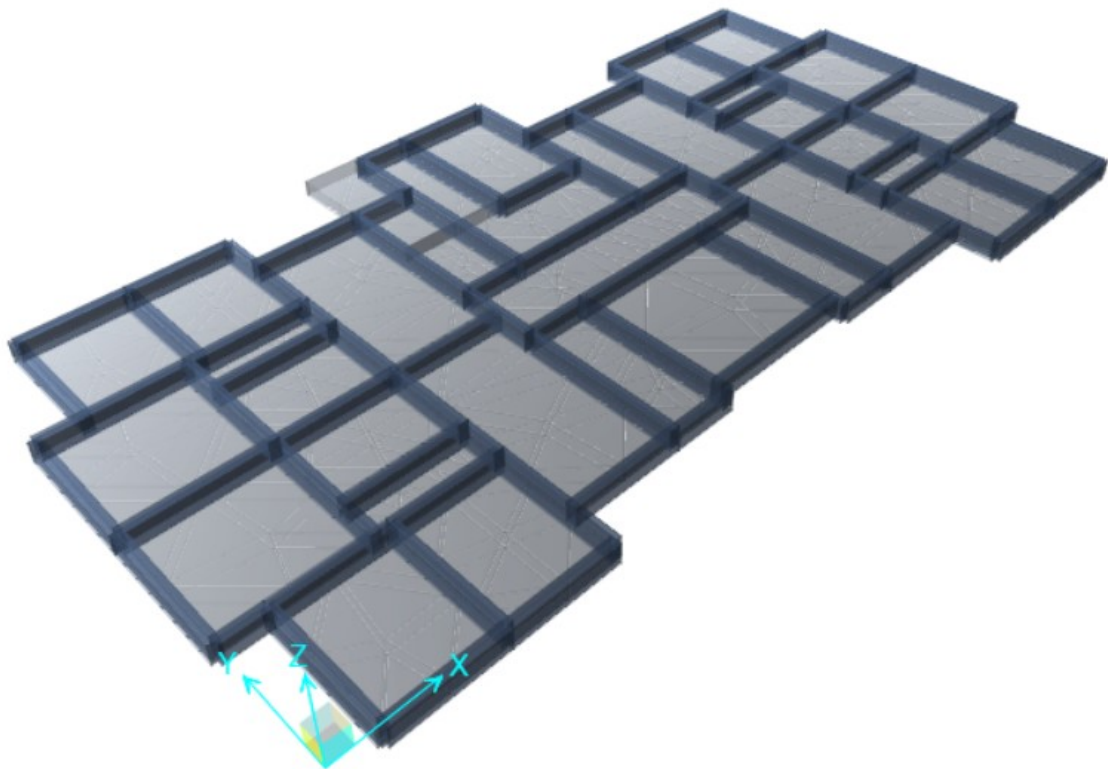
Modelamiento Subestructura Sistema MDL – Edificio Blesser. Vista 3D.
